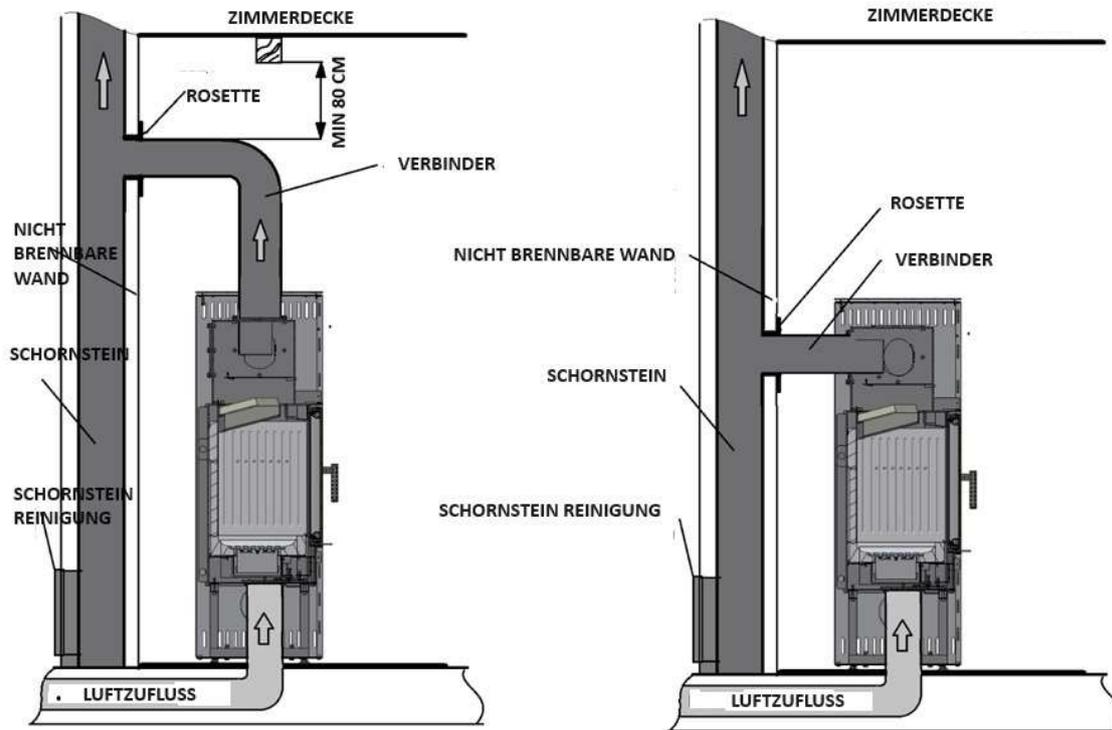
Verfahren zur Installation des Abgasanschlusses.
